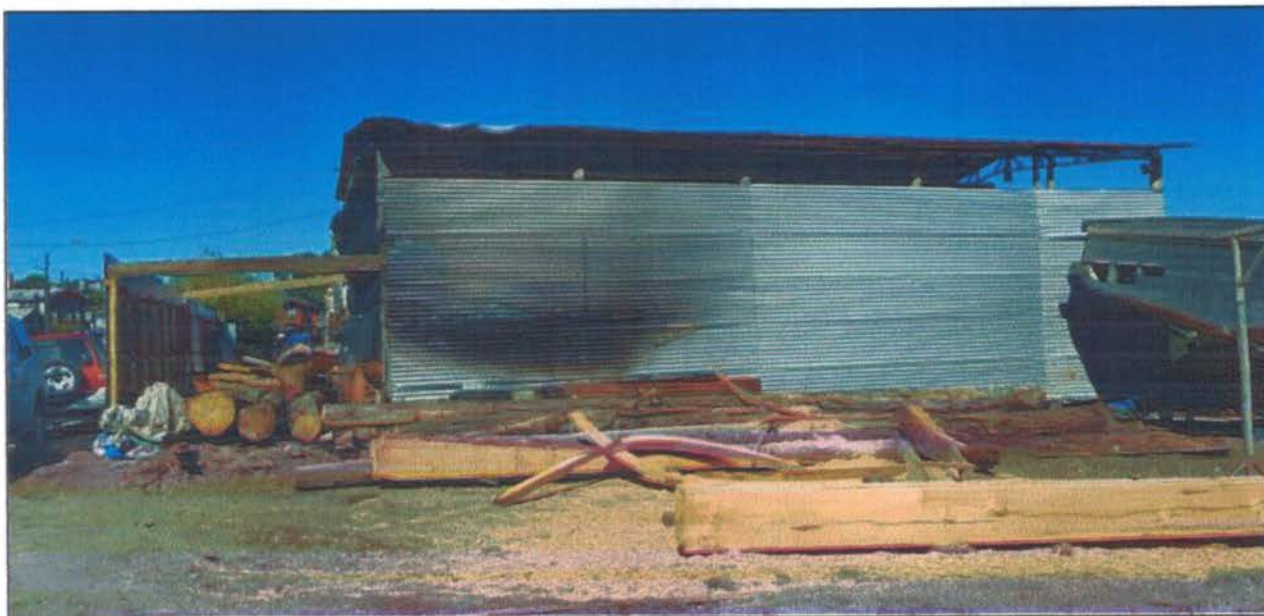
Esquema de galpón existente acondicionado acústicamente vista 1
